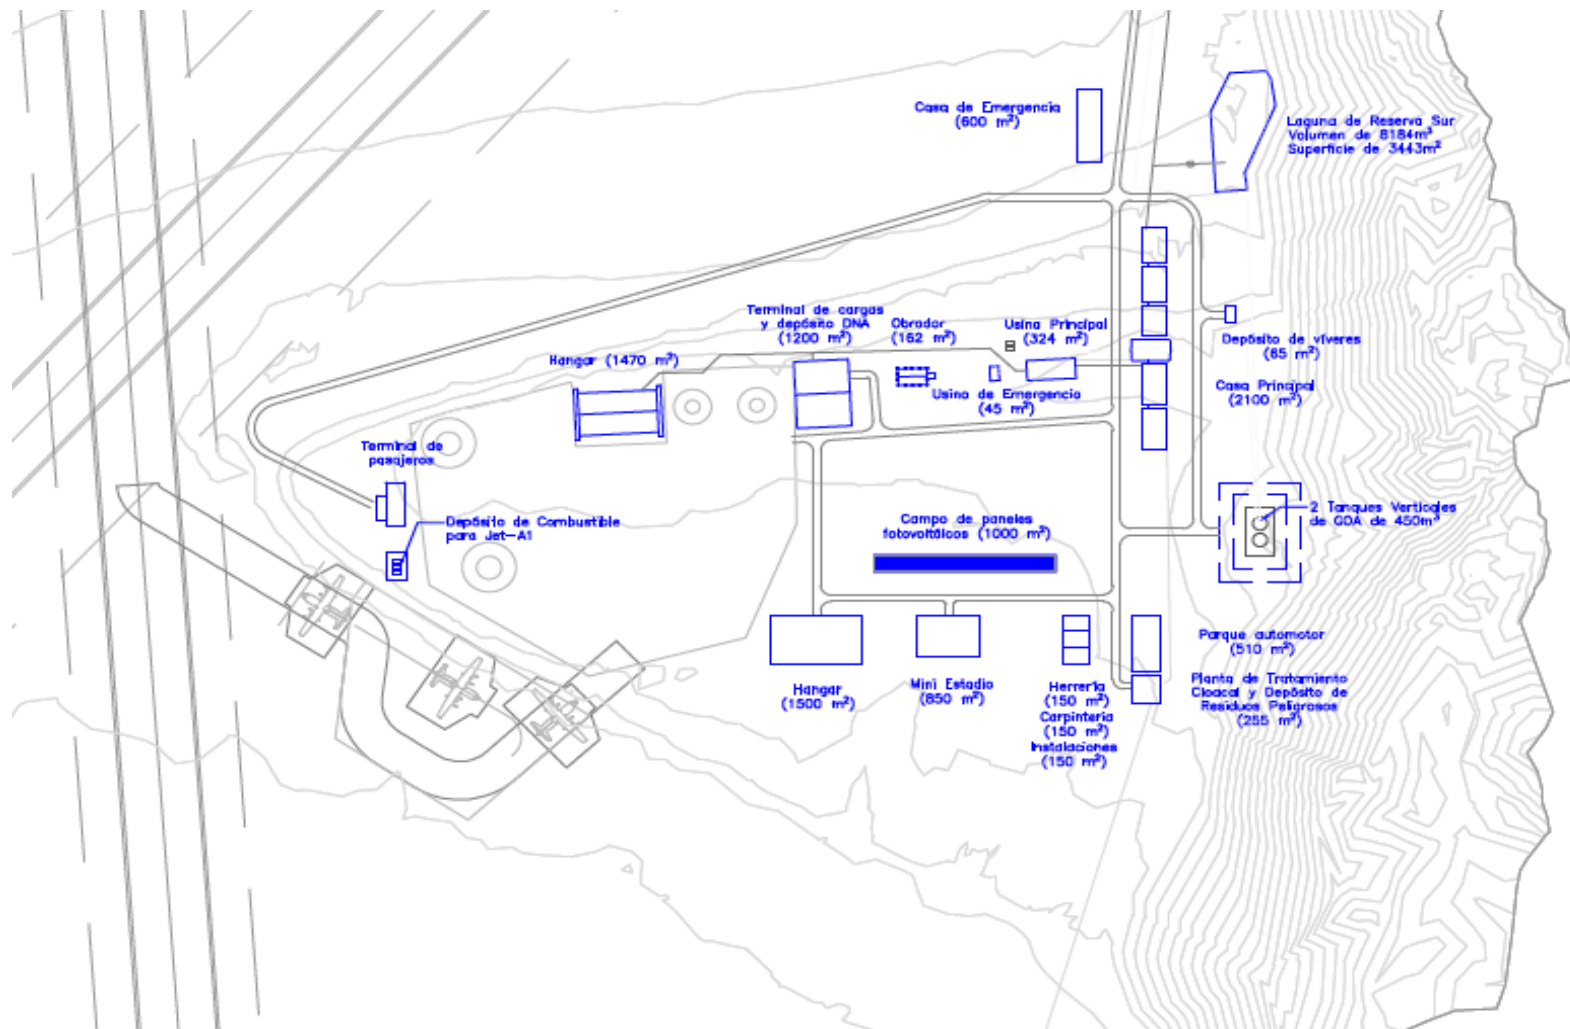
layout con la disposición original de las instalaciones de la zona central de la base en la terraza superior
